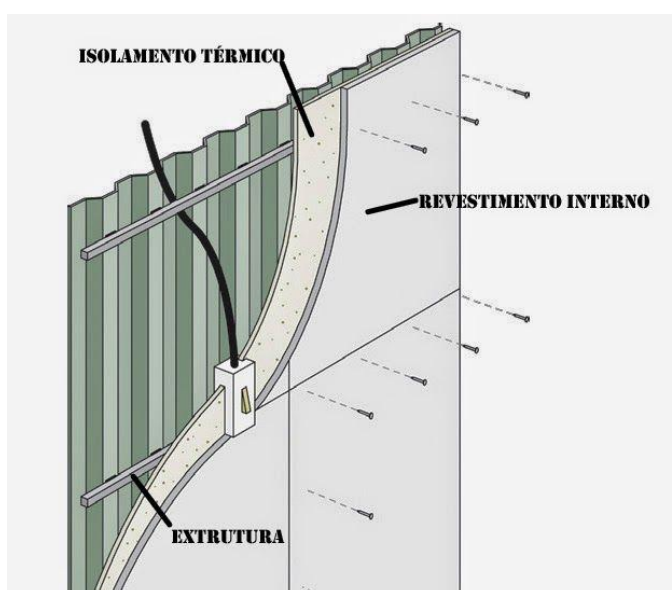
“Resultado após aplicação do isolamento termoacústico e do Drywall”
